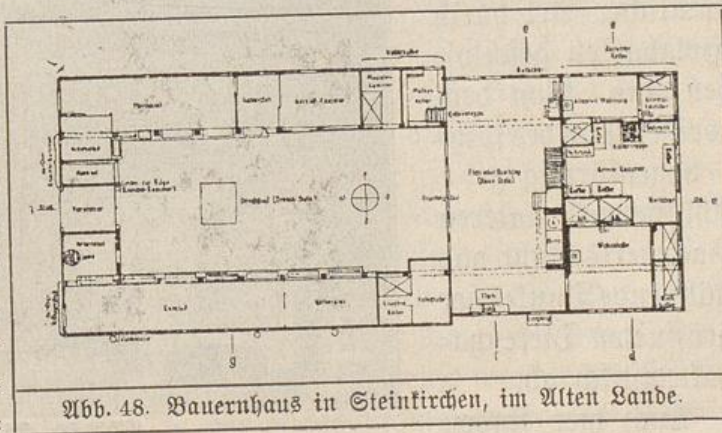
Bauernhaus in Steinkirchen, im Alten Lande.
